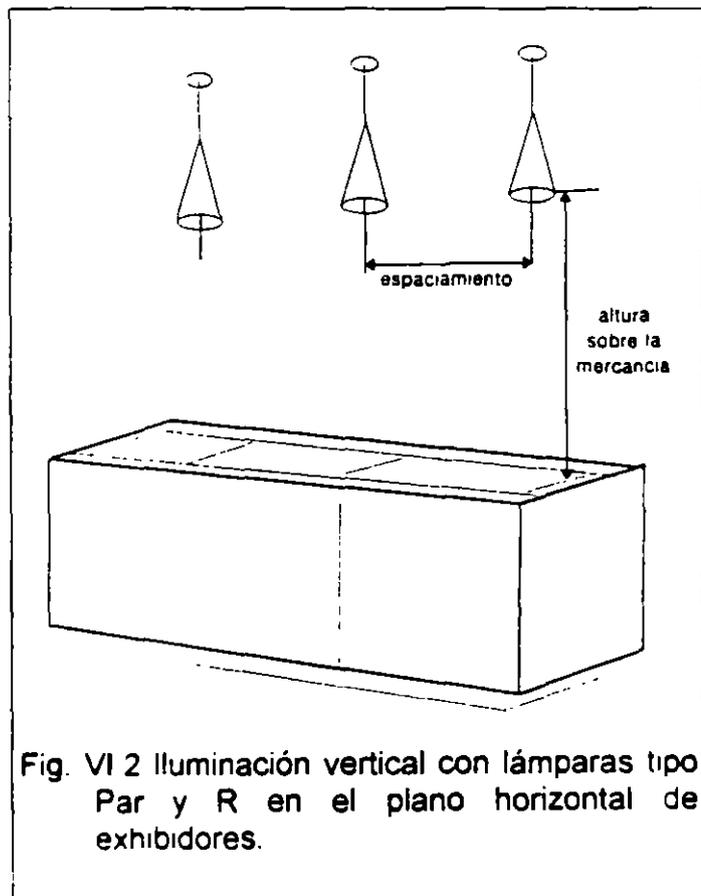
Iluminación vertical con lámparas tipo Par y R en el plano horizontal de exhibidores.
